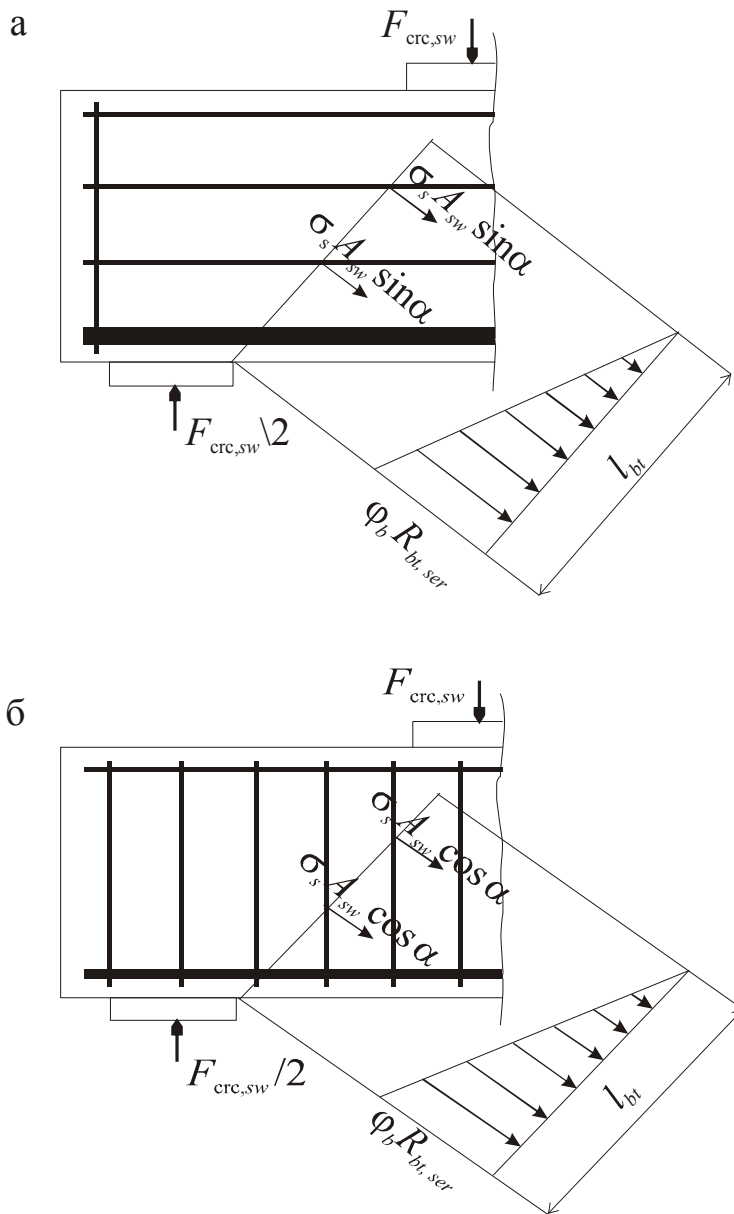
Схема предельных усилий в коротких балках, армированных распределенной арматурой при образовании наклонных трещин:
